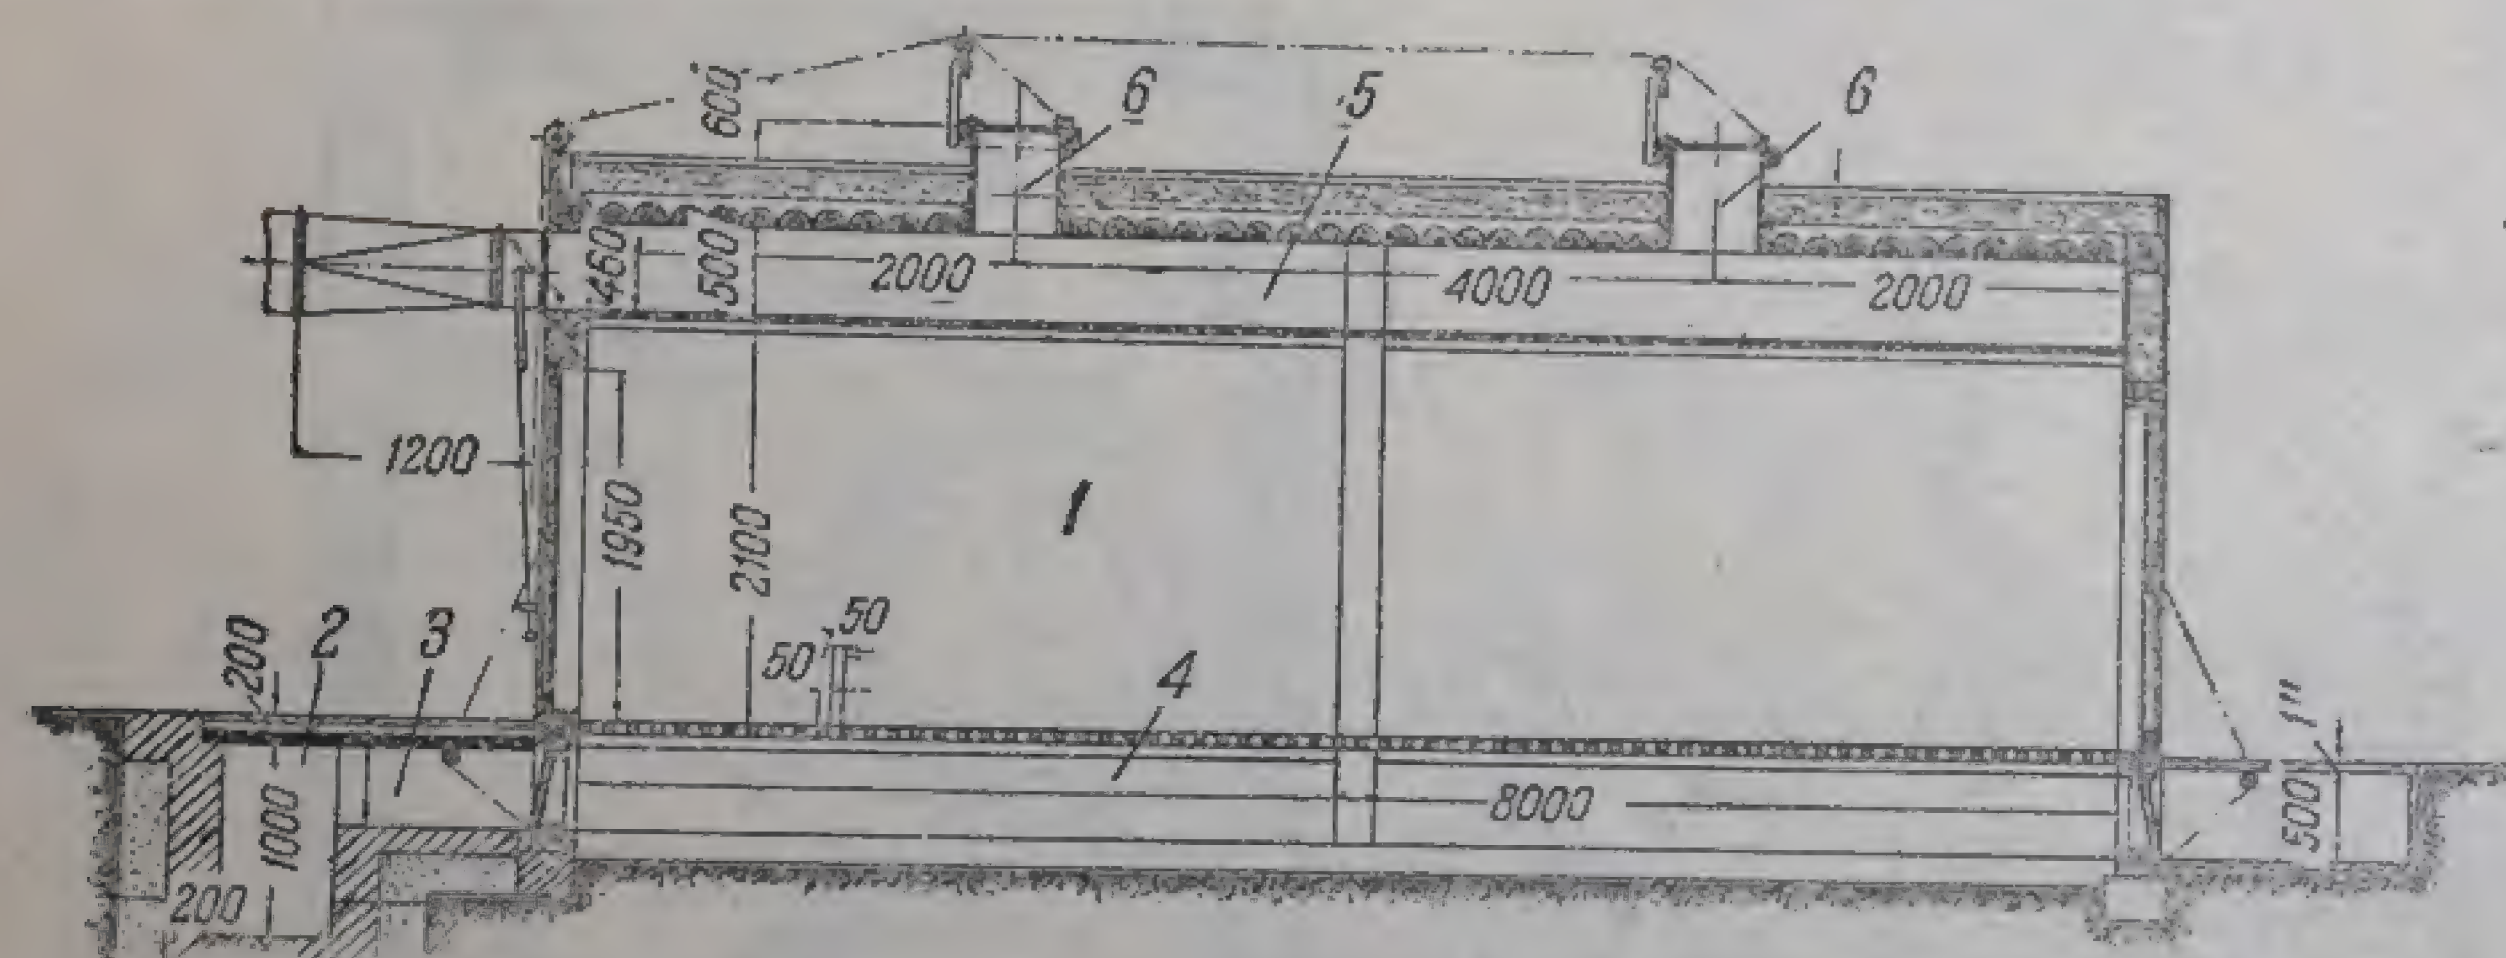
Поперечный разрез реконструированной сушилки для конопли: 1—камера сушилки, 2—канал, подводящий нагретый воздух к сушилке, 3—короб для распределения нагретого воздуха, 4—воздуховод камеры, 5—сборный короб, отводящий отработанный воздух, и 6—трубы для охлаждения камер перед выгрузкой.
